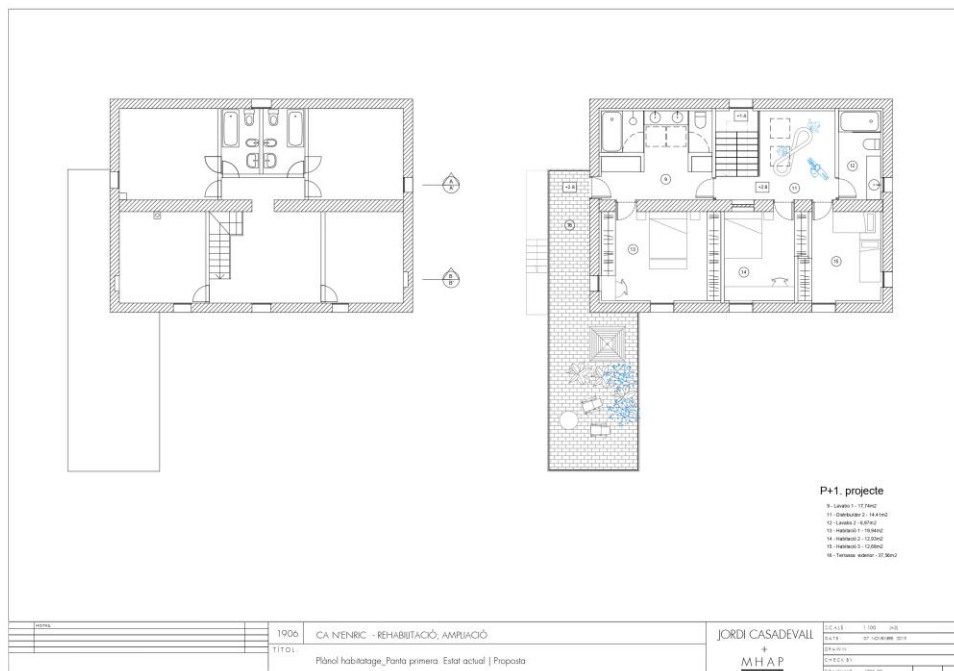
Planta primera. A l'esquerra hi trobem la distribució actual i a la dreta la proposta de projecte
